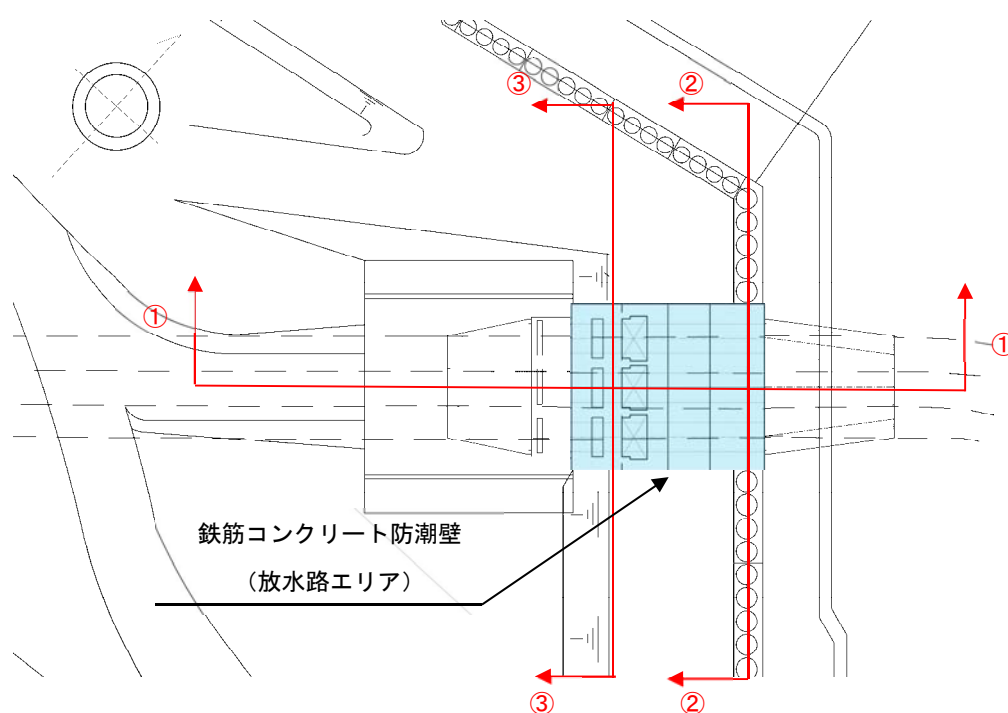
鉄筋コンクリート防潮壁（放水路エリア）の平面図
